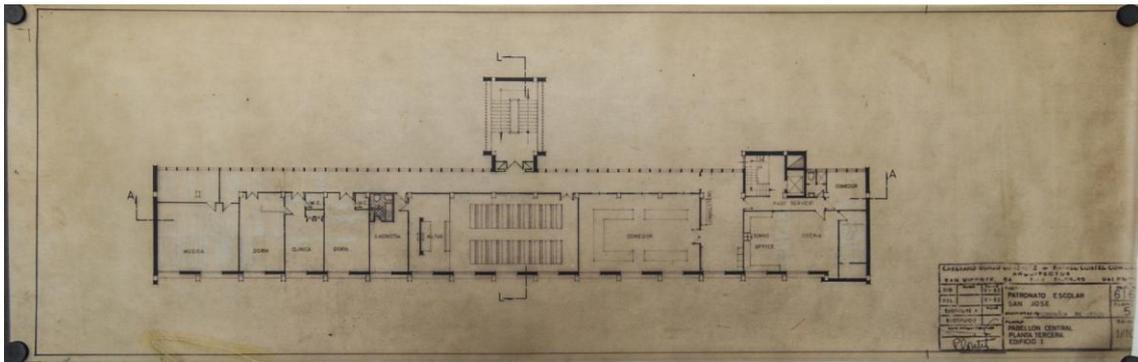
Planta segunda. *Archivo Escuelas San José.
